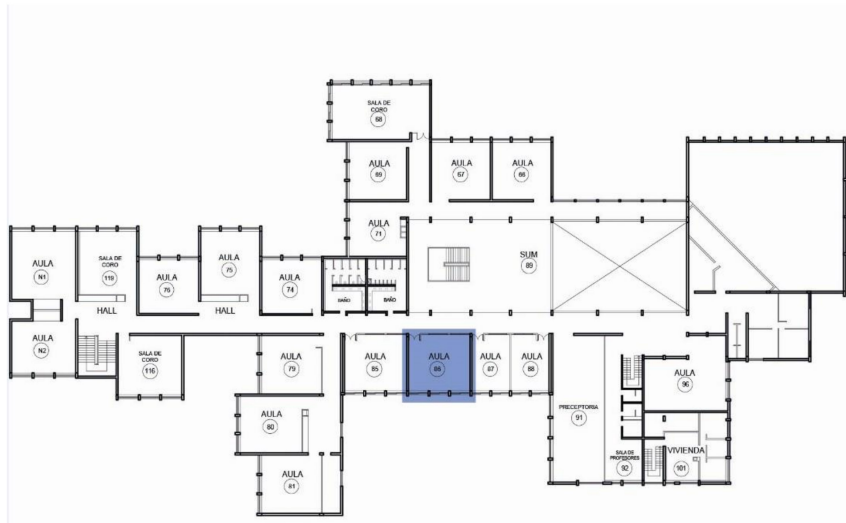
y 10. Planimetría General del Edificio Zípoli con ubicación del local y Planta General del Aula.
